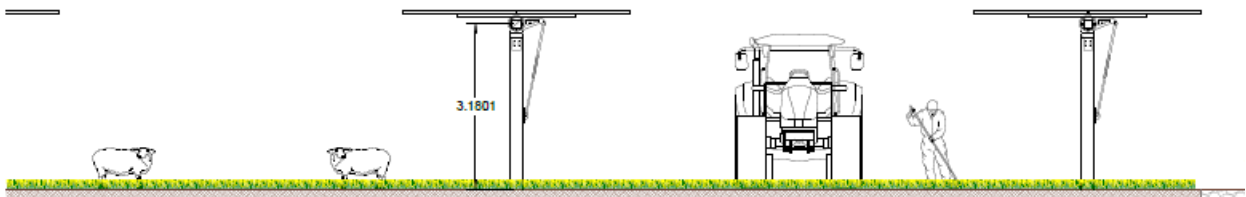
| Sezione trasversale tipologica interfilare delle strutture di sostegno dei moduli
